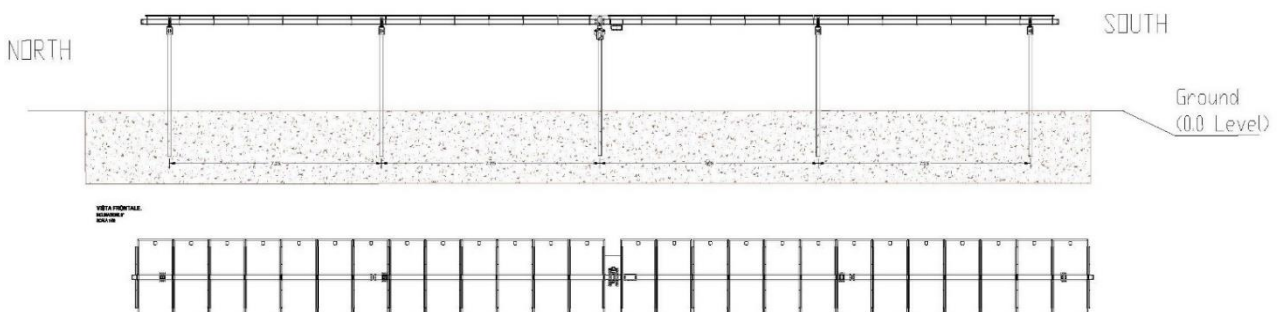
Vista laterale e vista dall'alto della singola stringa da 26 moduli
